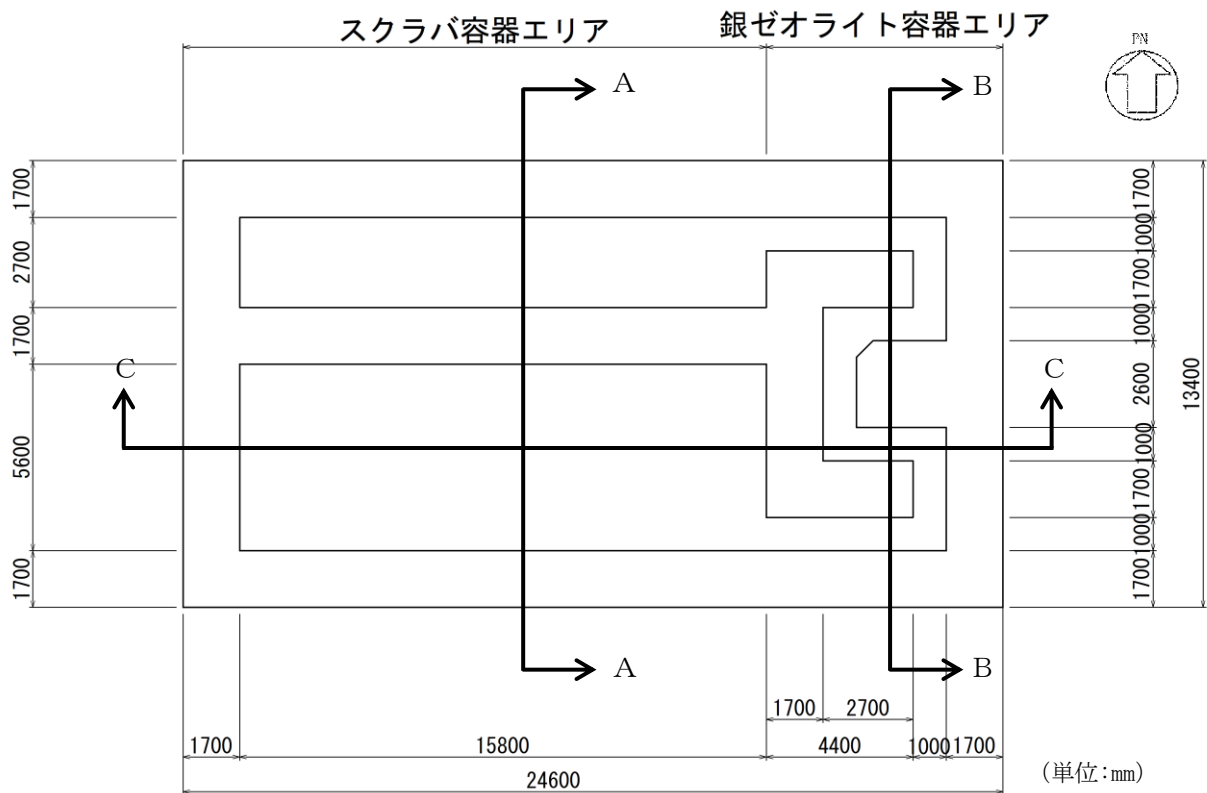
第 1 ベントフィルタ格納槽 平面図
